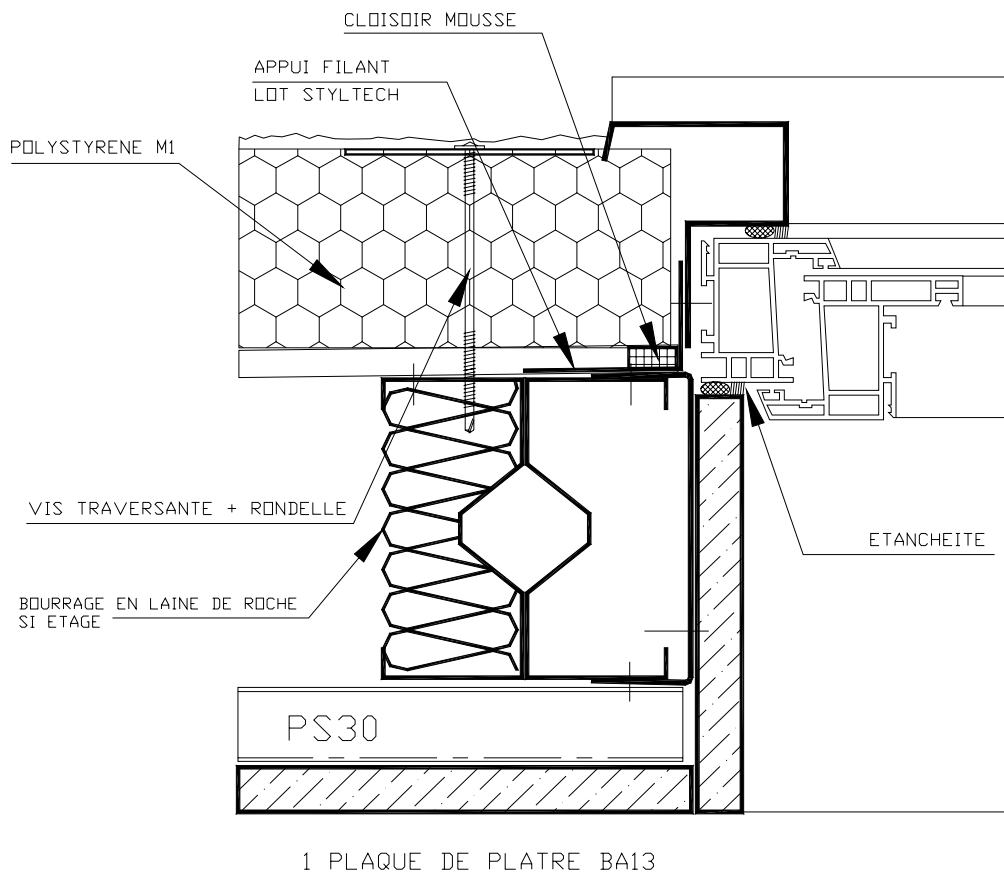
is – Coupe horizontale sur fenêtre – Tableau – Menuiserie demi-mur
